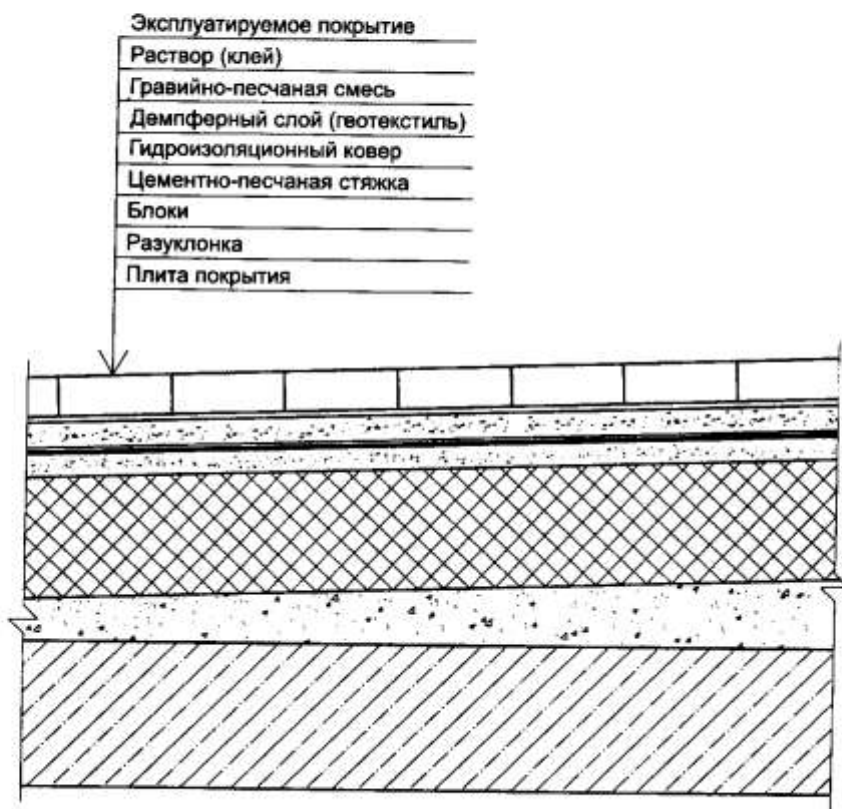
Тепловая изоляция совмещенной эксплуатируемой кровли
